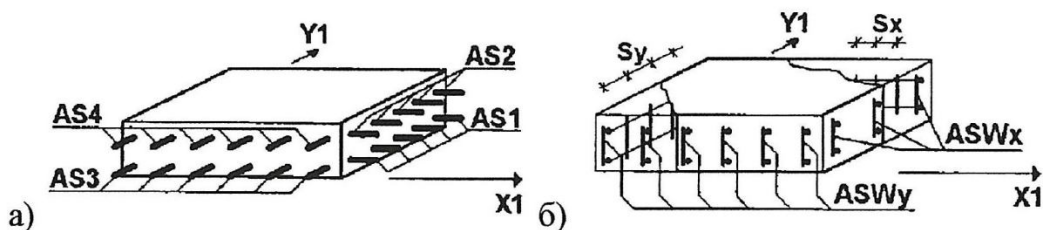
Розташування а) поздовжньої і б) поперечної арматури відносно місцевих вісей у плитах
